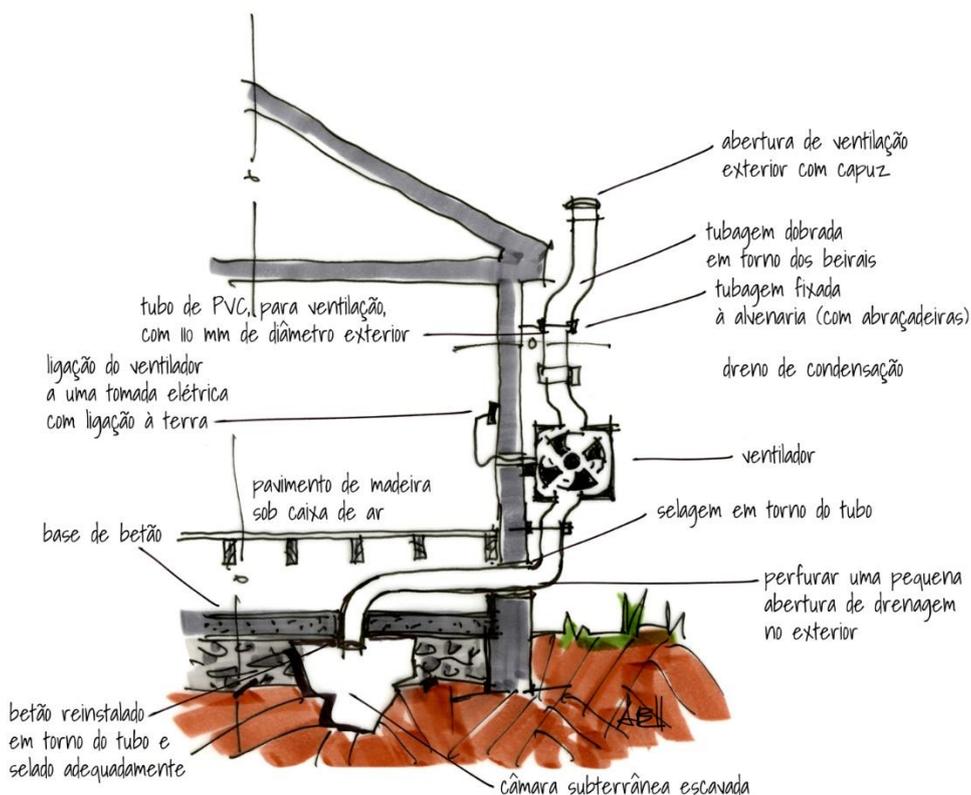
Exemplo de sistema de despressurização do terreno debaixo da laje térrea, com condutas e ventilador localizados no exterior
